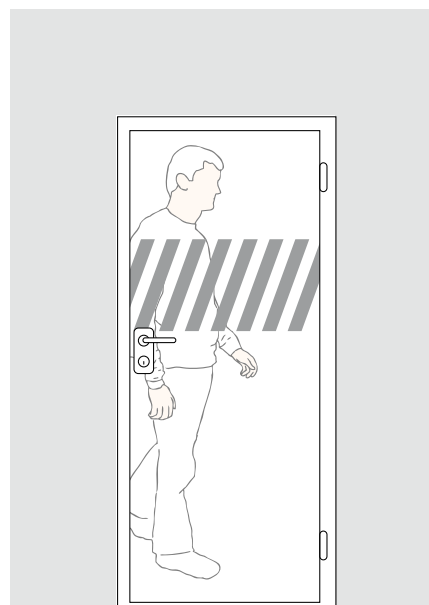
Zasada projektowania drzwi rozwieranych, będących alternatywą dla drzwi obrotowych lub wahadłowych.
